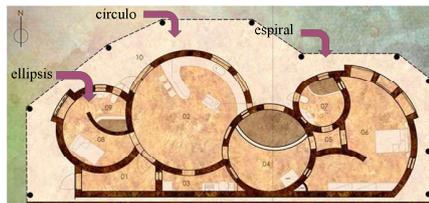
Planta del proyecto arquitectónico de la vivienda "Susurros del viento" | Fuente: "Debarro Arquitectura"
